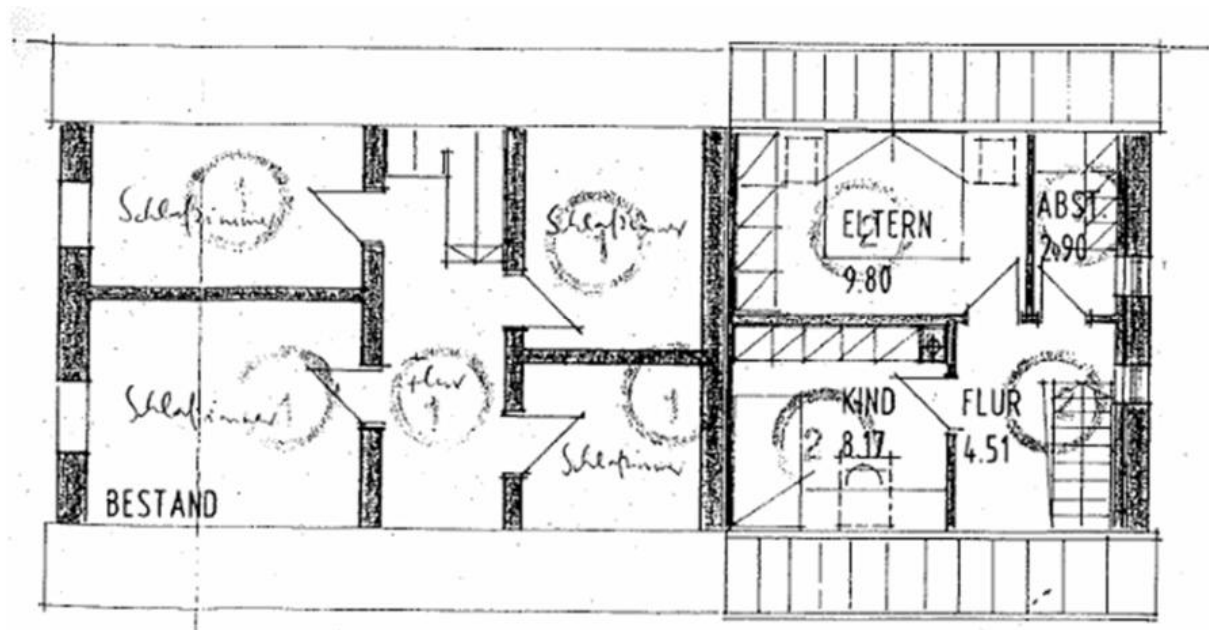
Grundriss Dachgeschoss (Auszug aus der Bewilligung 1994)
